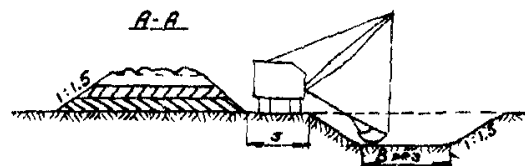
Схема отсыпки насыпи экскаватором-драглайном из резерва
